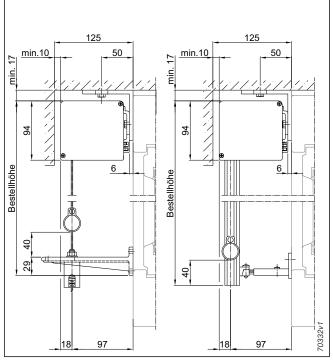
Senkrecht-Markise 490, Deckenmontage
